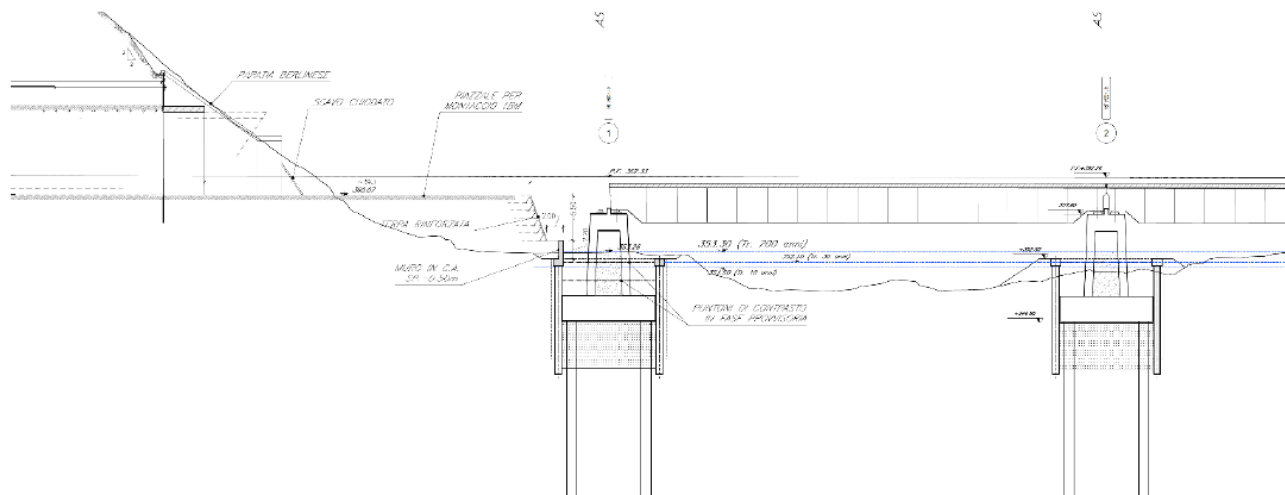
Imbocco lato Bari GN01 –allargamento piazzale di lavoro antistante la galleria - Profilo longitudinale
